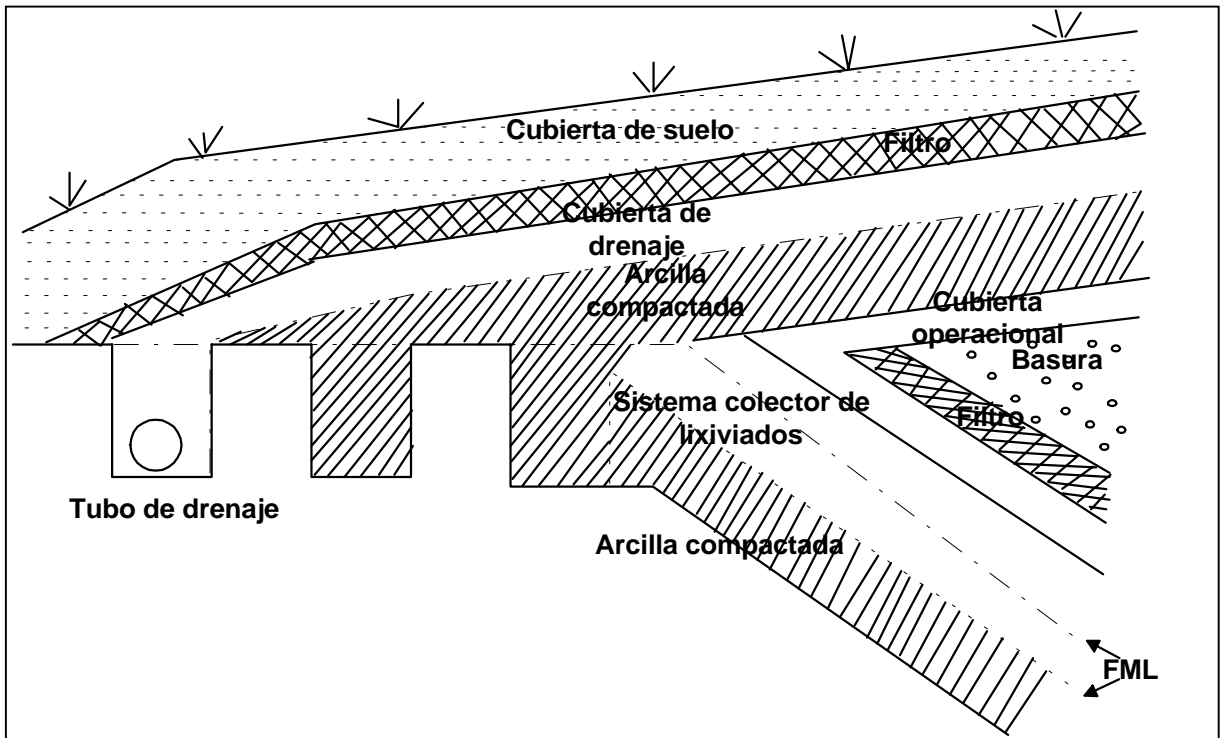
Sistema de impermeabilización y dren para lixiviados (Fuente: Mc Bean, Rovers & Farquhar. *Solid waste landfill. Engineering and design*; 1995).
